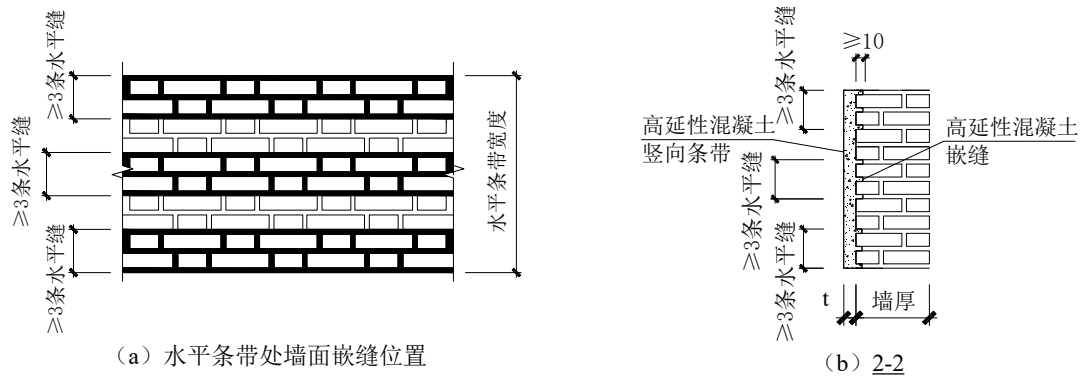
高延性混凝土水平条带嵌缝示意图
